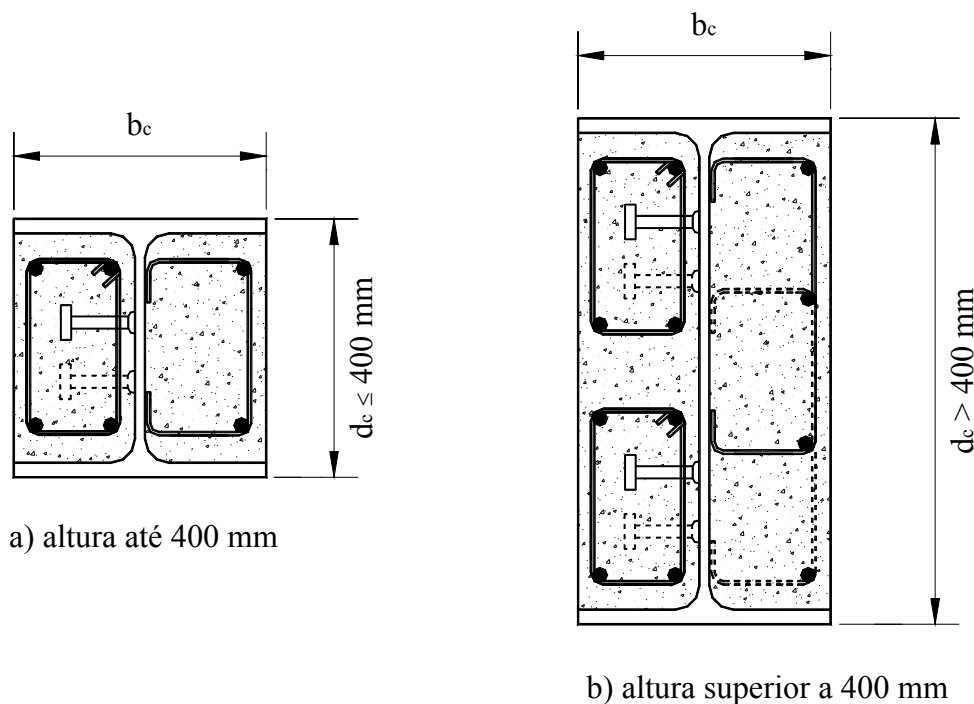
Disposições construtivas para pilares mistos parcialmente revestidos concreto
